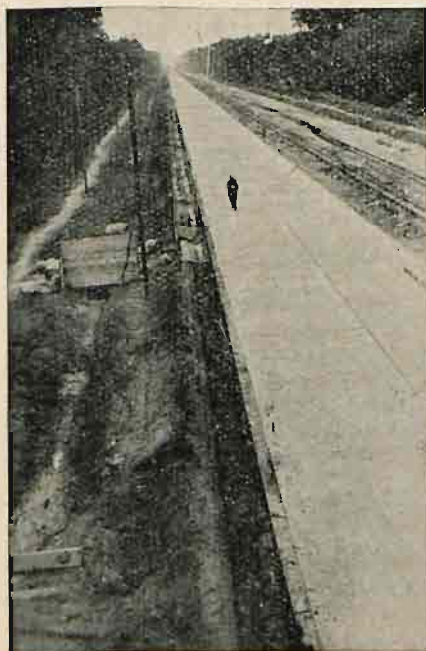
Wykończanie budowy jezdni betonowej (Fot. W. Gr.).
